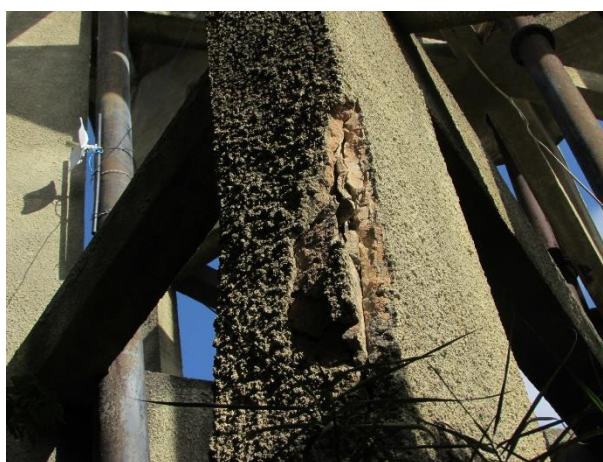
Deslocamento do concreto com corrosão da armadura no pilar.
